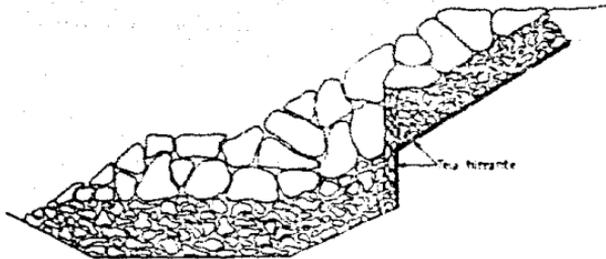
SECCIÓN TRANSVERSAL DEL MURO DE ENROCAMIENTO DESPUES DE LA RECONSTRUCCION
